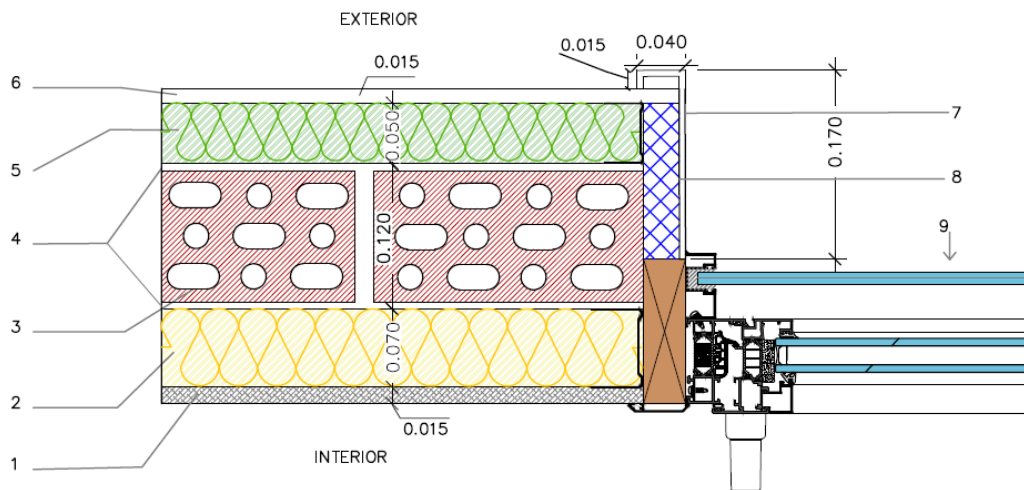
Sección constructiva, corte horizontal, de la propuesta de fachada tradicional + SATE a estudio.
